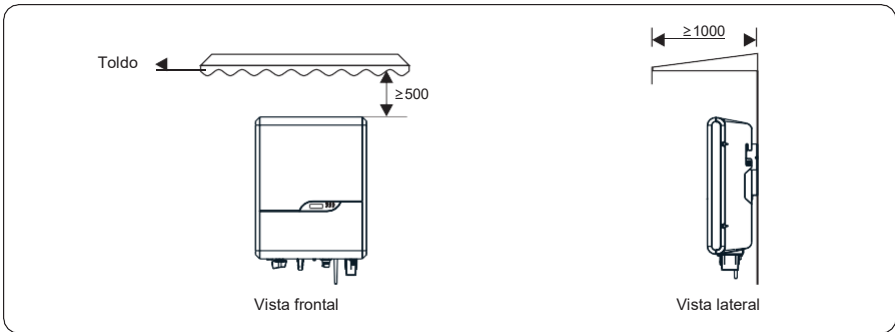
Entorno de instalación con cubierta (unidad: mm)
